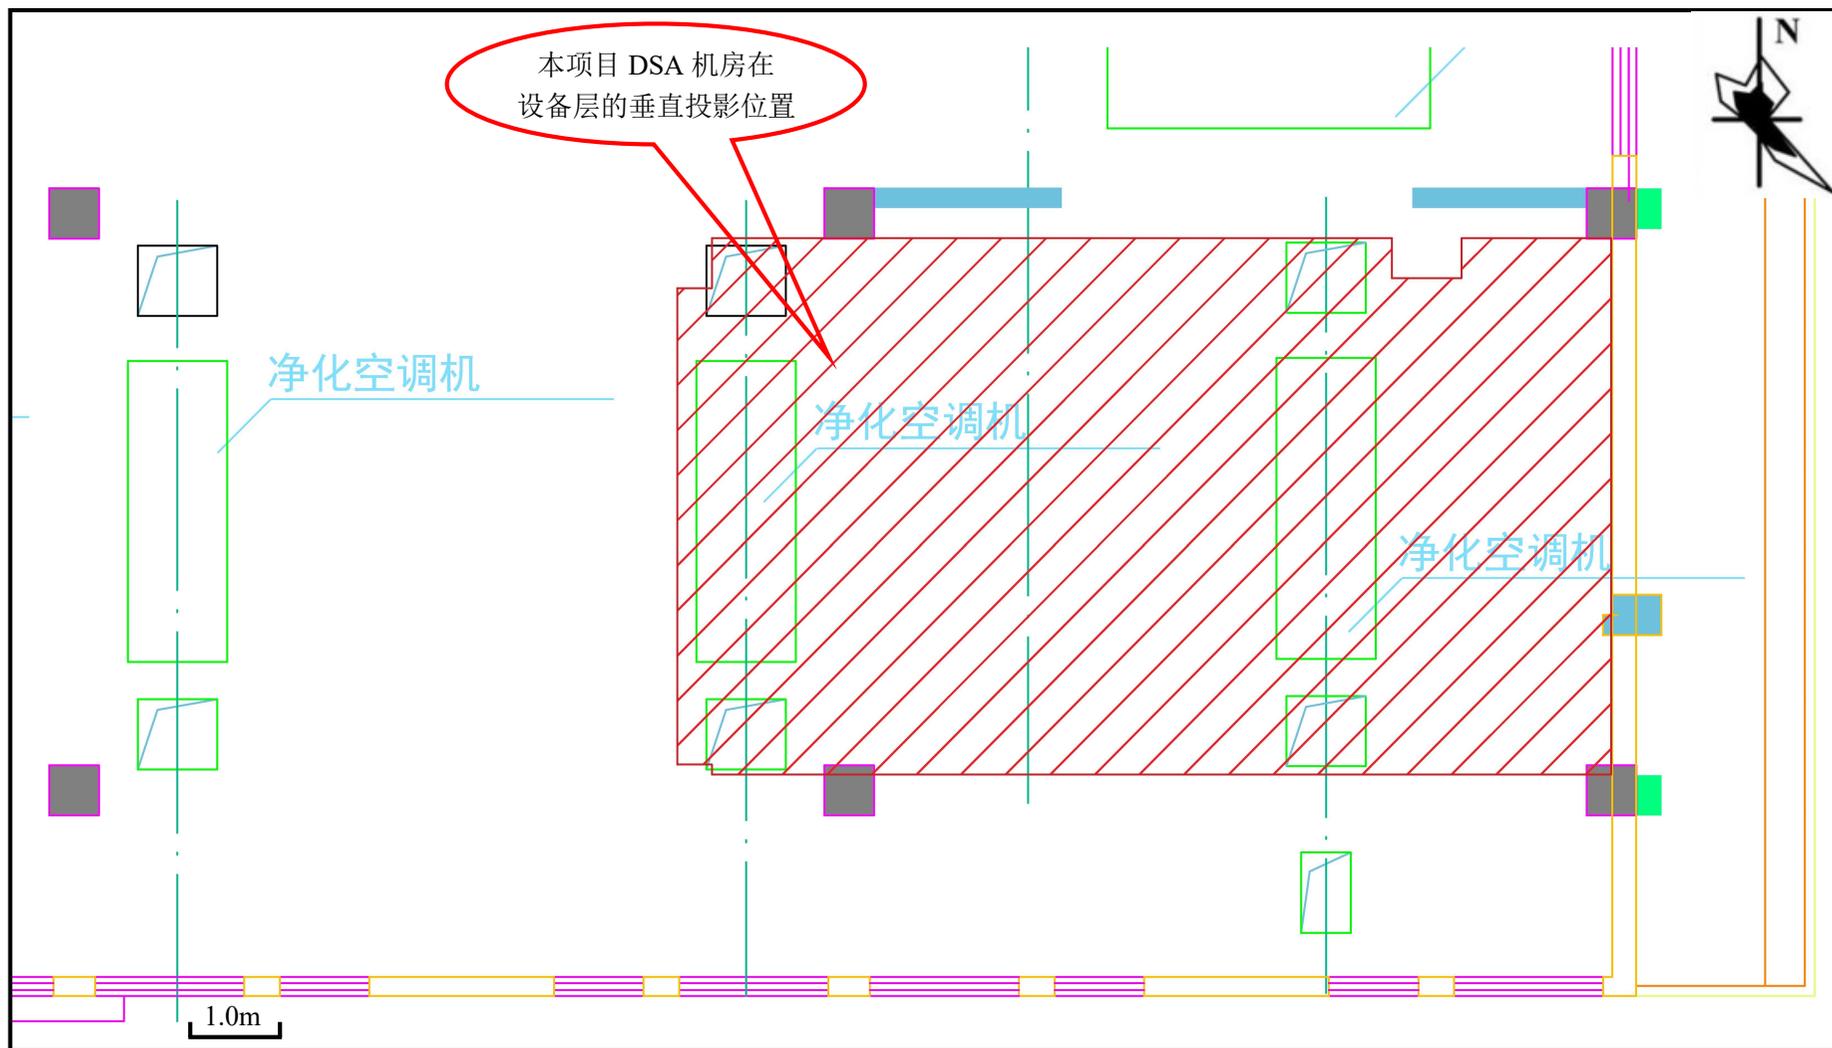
福建省肿瘤医院内科大楼设备层（局部）平面布置图
